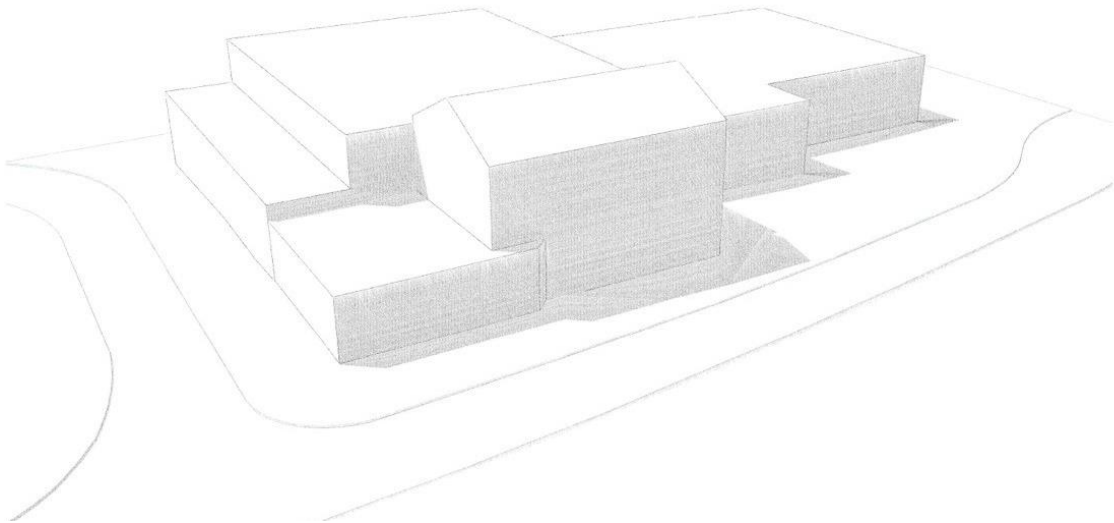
Ansicht Fassadengliederung neues Gebäude Richtung Tannenstrasse
